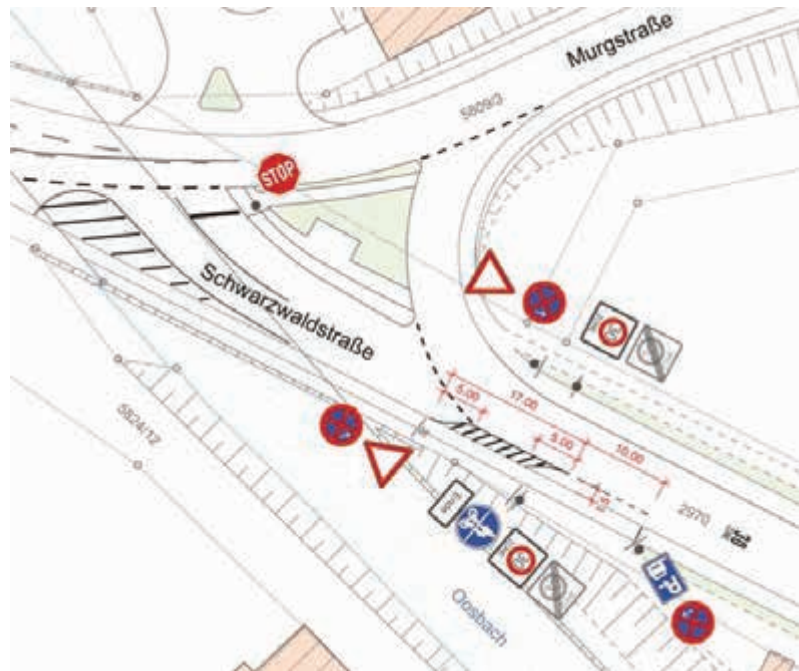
Planungen zum Knotenpunkt Murgstraße /Schwarzwaldstraße
